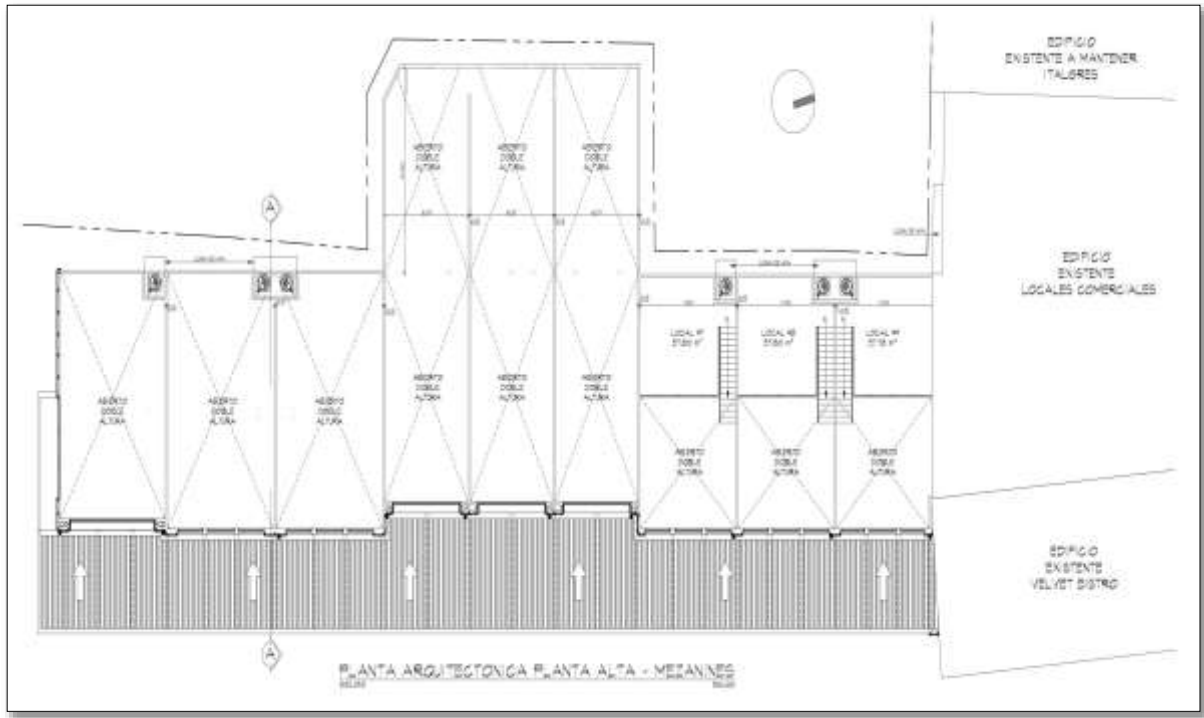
Planta arquitectónica PLANTA ALTA - MEZANINE. Fuente: Plano del proyecto
